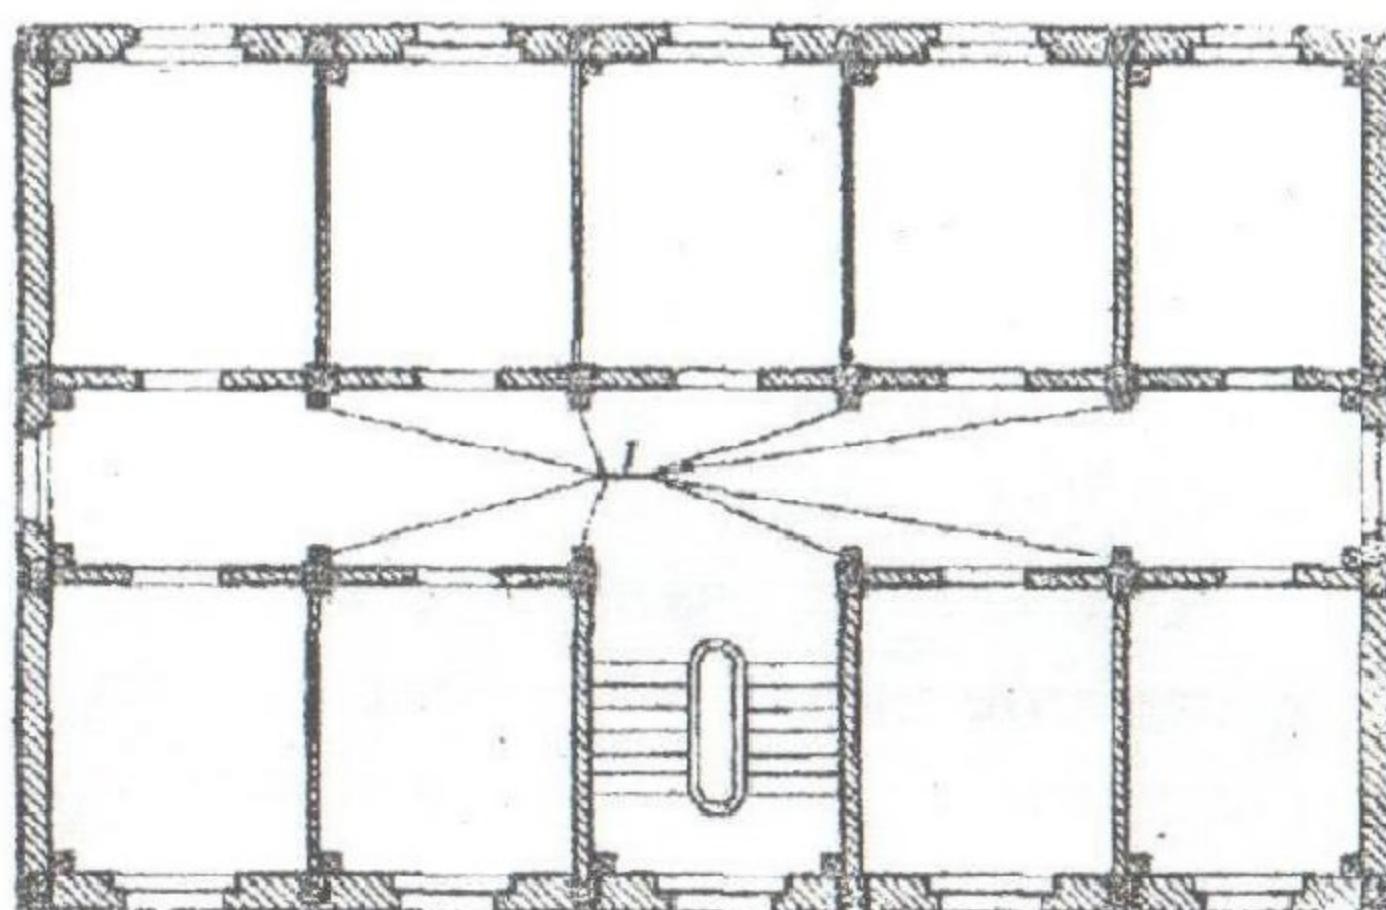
Обрушение каркасного здания на месте путем подрывания всех стоек каркаса в одном уровне:
